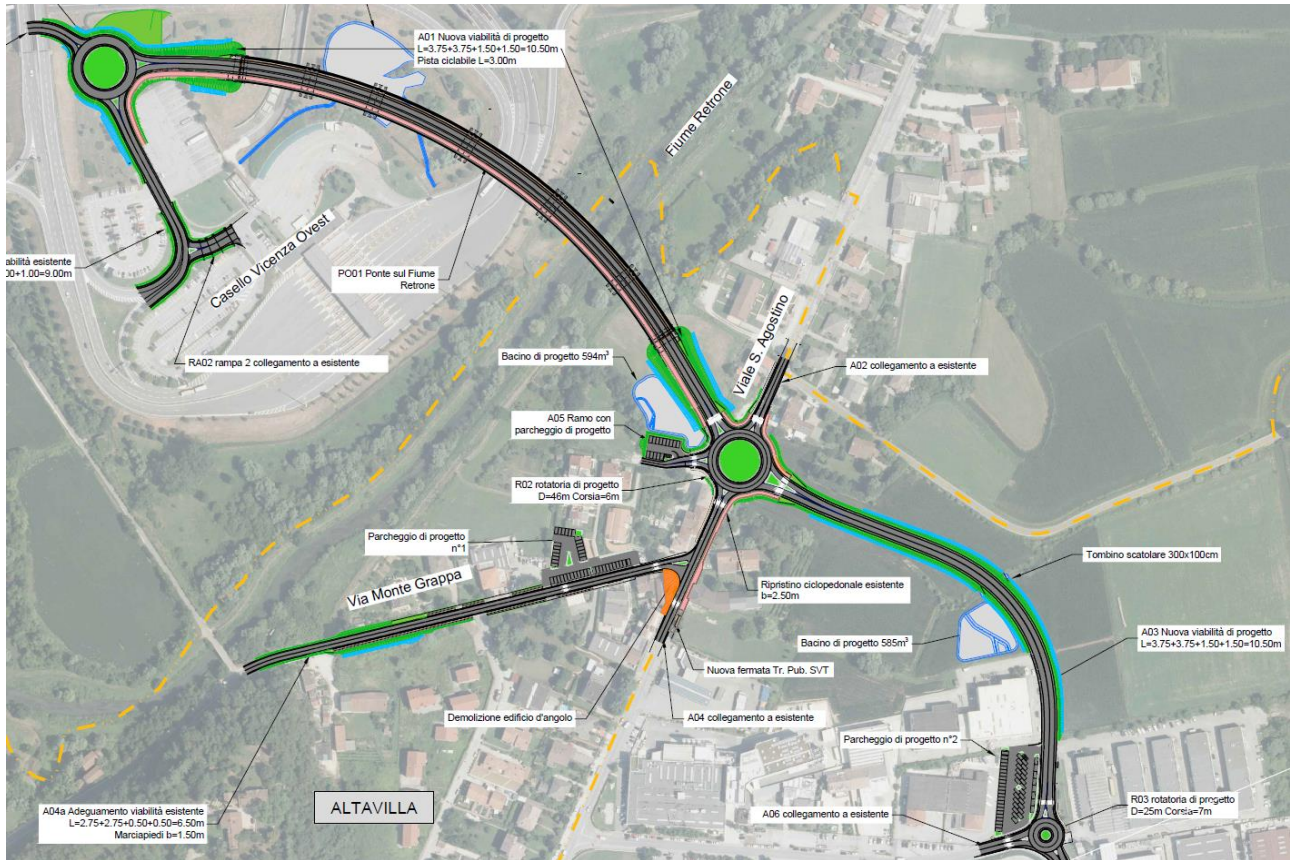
Stralcio della planimetria di progetto generale (Doc. Rif [1])
